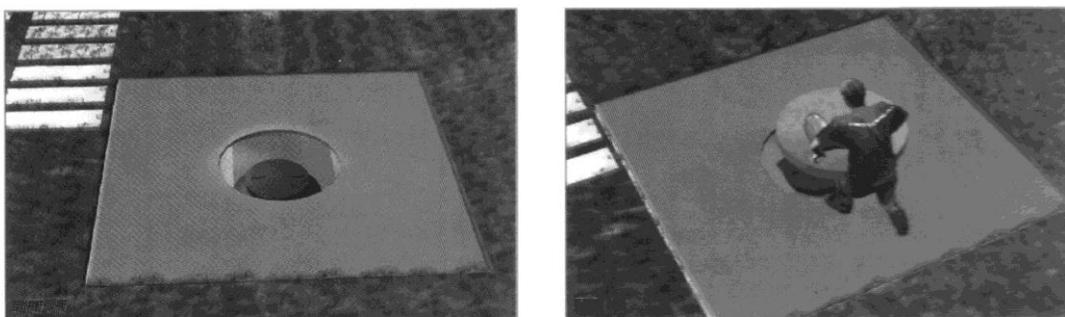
Se puede cubrir la fosa con concreto armado.
